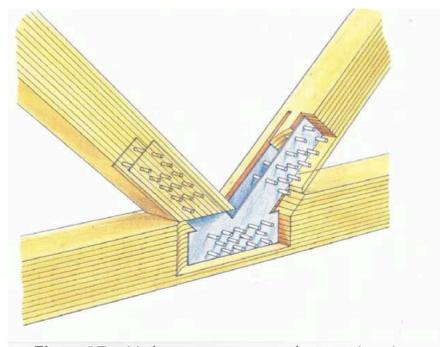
Uniones entre vigas de la estructura principal (Abrahamsen, 2014).
